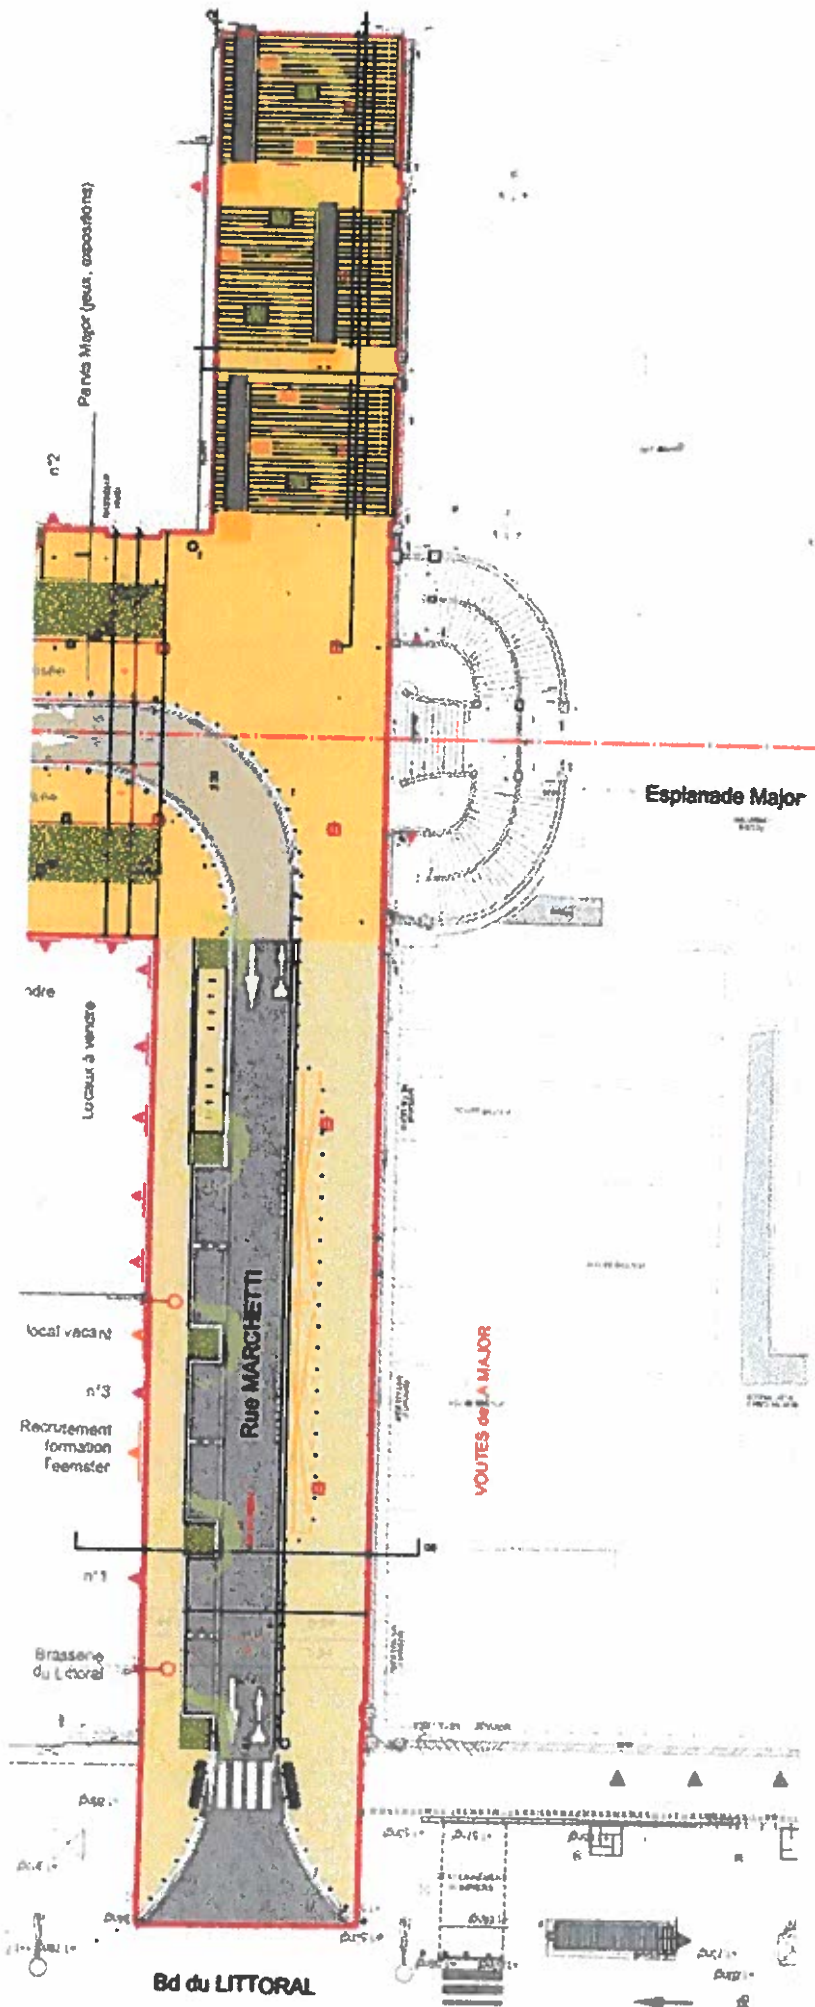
Plan Général des Travaux (6/6) – Section Rue Marchetti
